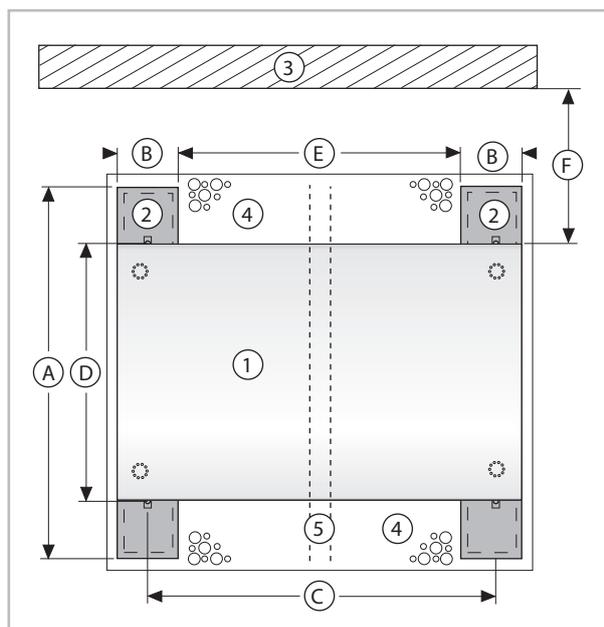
Dimensions de la semelle filante (vue du dessus)
